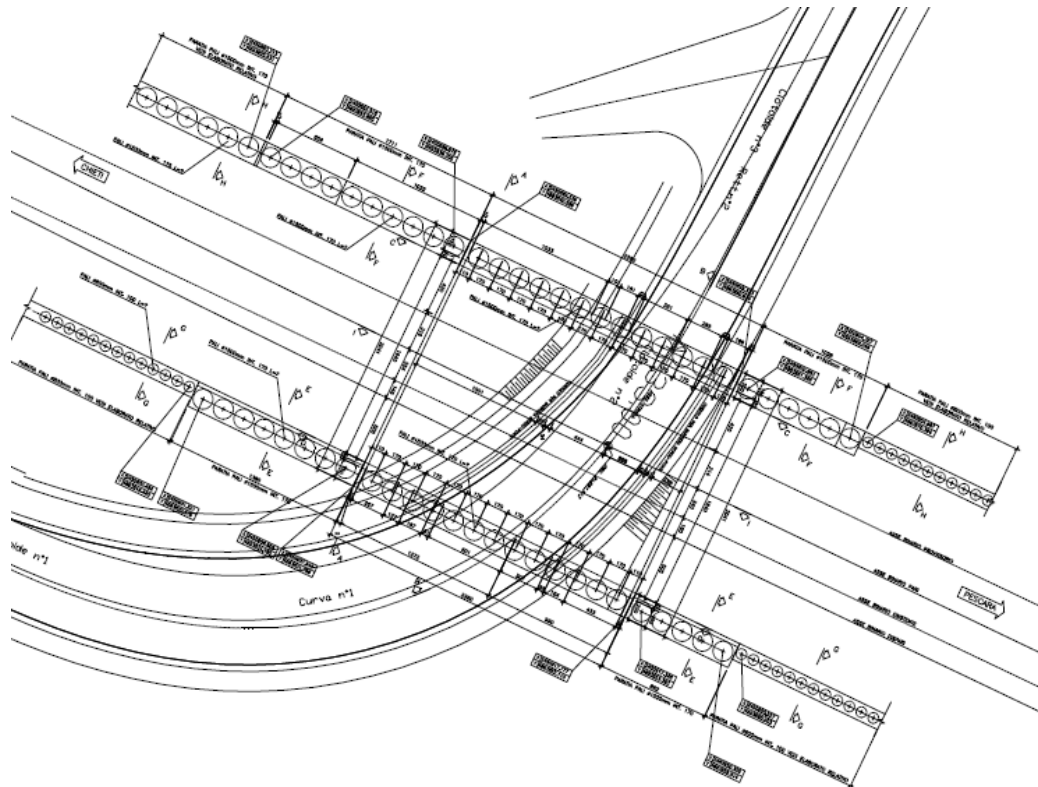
Ubicazione dell'intervento - Stralcio planimetrico
